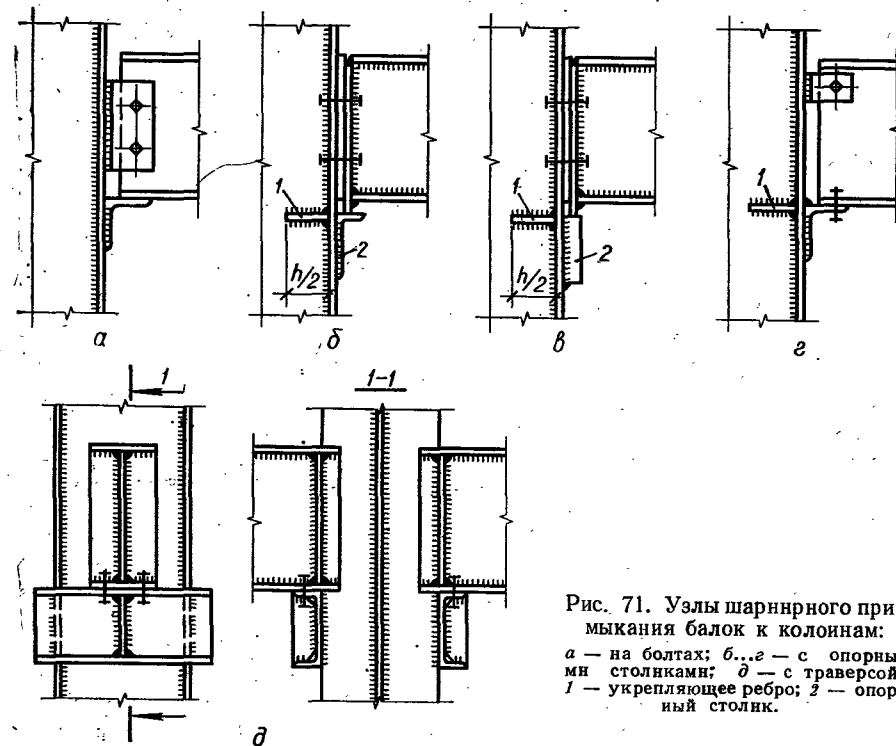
Узлы шарнирного примыкания балок к колоннам:
